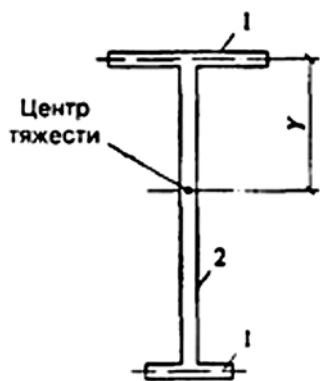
План поперечной стены и простенков продольных стен: 1 – простенок продольной стены; 2 – поперечная стена
